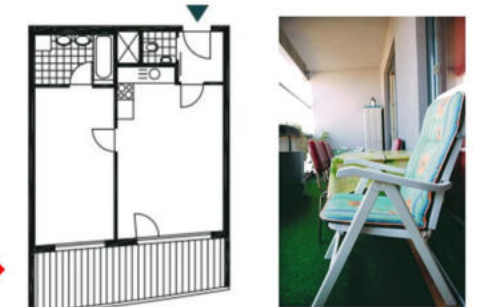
Grundriss Wohnung / Foto Loggia (Buch „Wohnen in Wien, 20 residential buildings by Albert Wimmer“, S. 121 /123)
